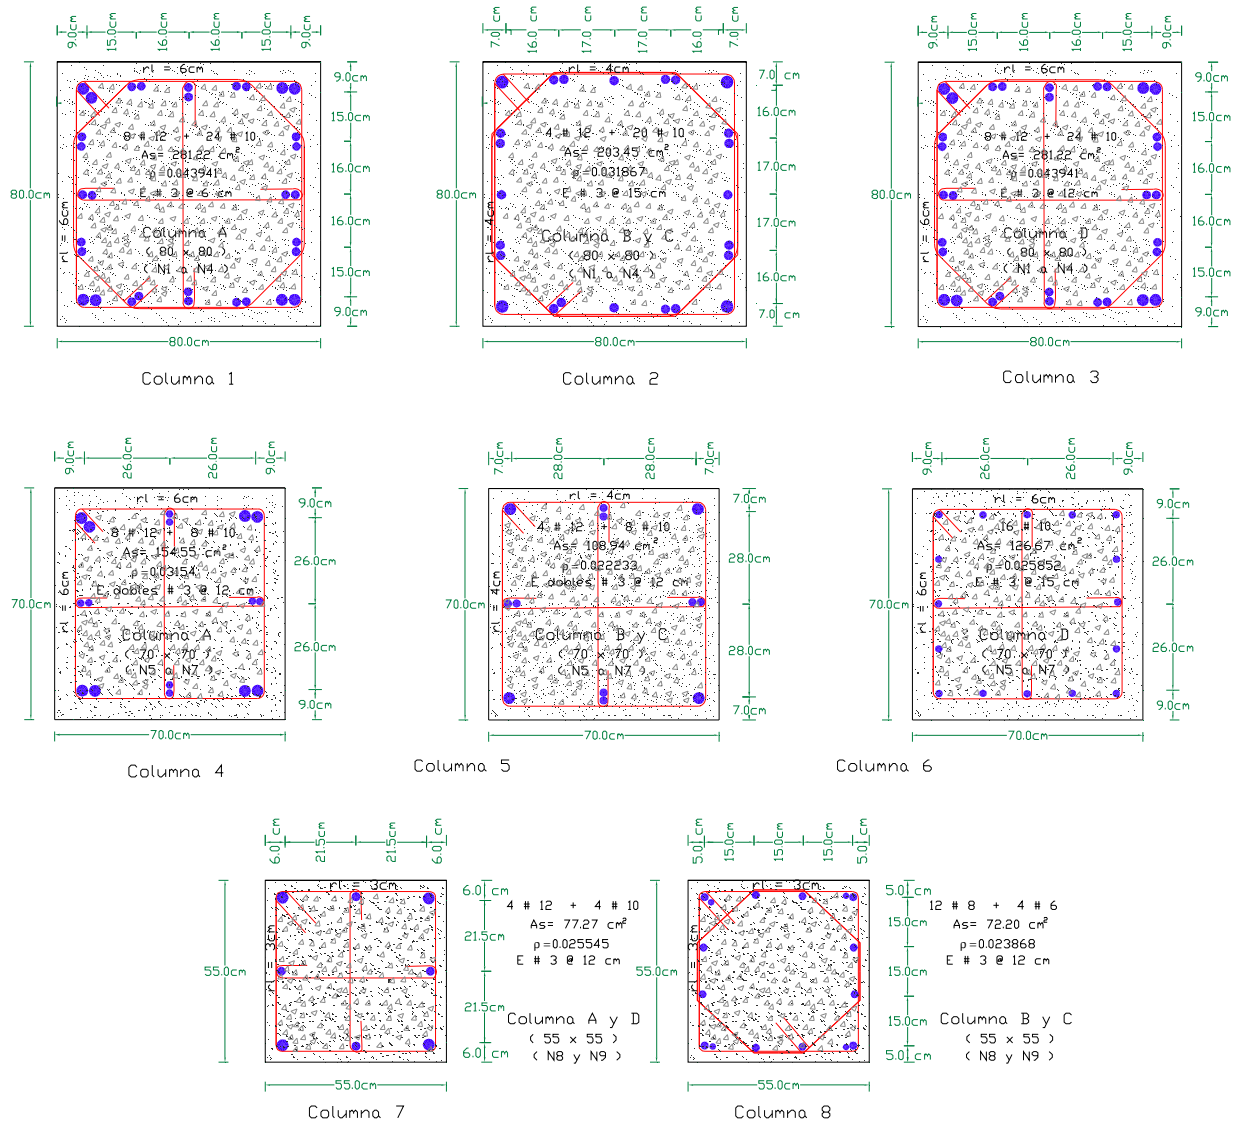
Dimensiones y armado de columnas, edificio III_9
